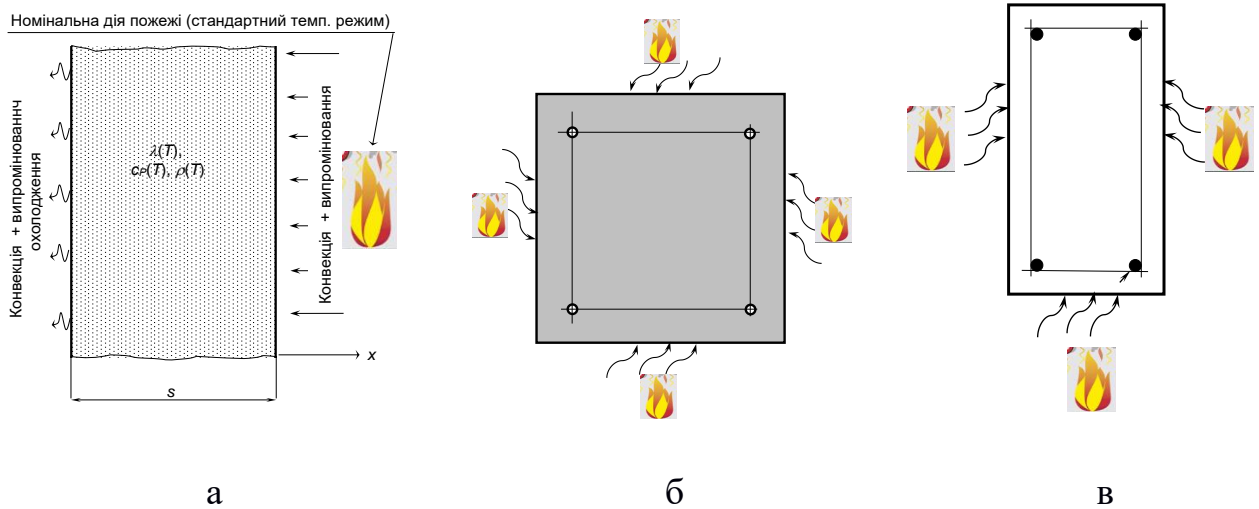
Схеми теплового впливу на несучі будівельні конструкції:
